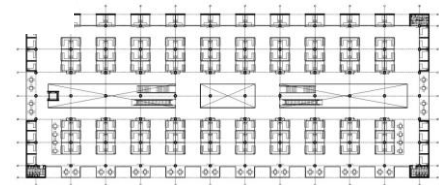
plano planta primer nivel, distribución con ejes perpendiculares, esqueleto de pescado. Imagen de: www.plataformaarquitectura.com, año 2011
